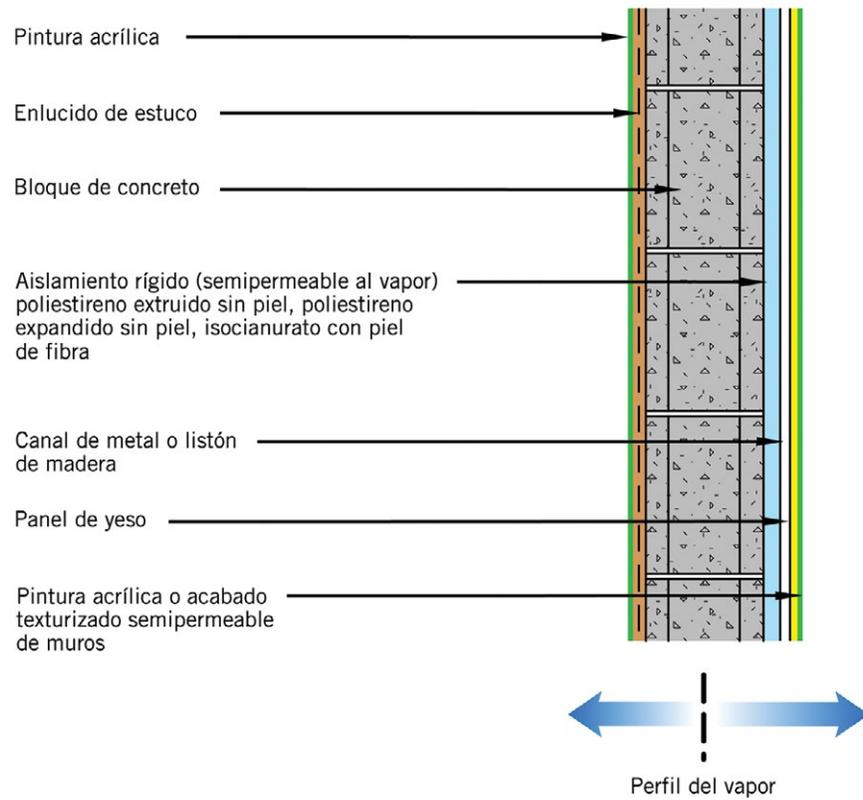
Bloque de Concreto con Aislamiento Interior Rígido de Entramado de Muro con Aislamiento de Cavidades y Estuco
